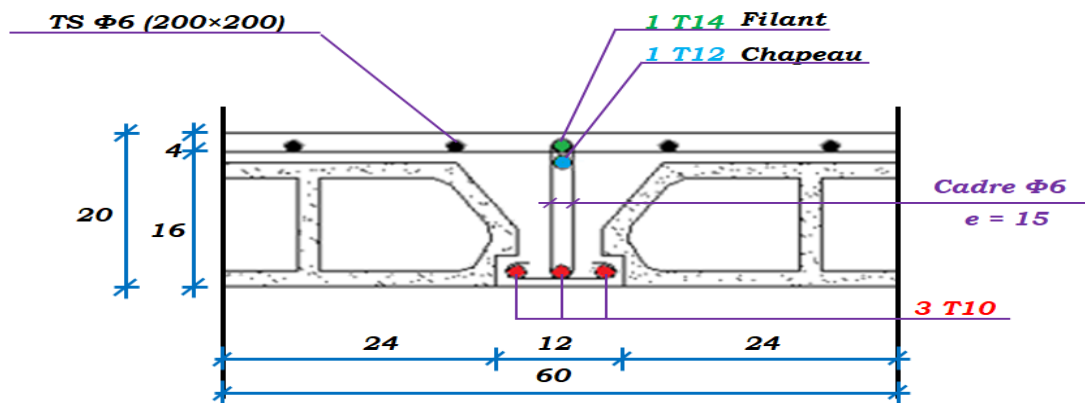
Schéma de ferrailage de la dalle de compression.
